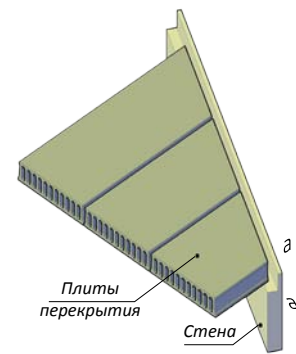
Схема опоры срезанной наискось многопустотной плиты перекрытия.
